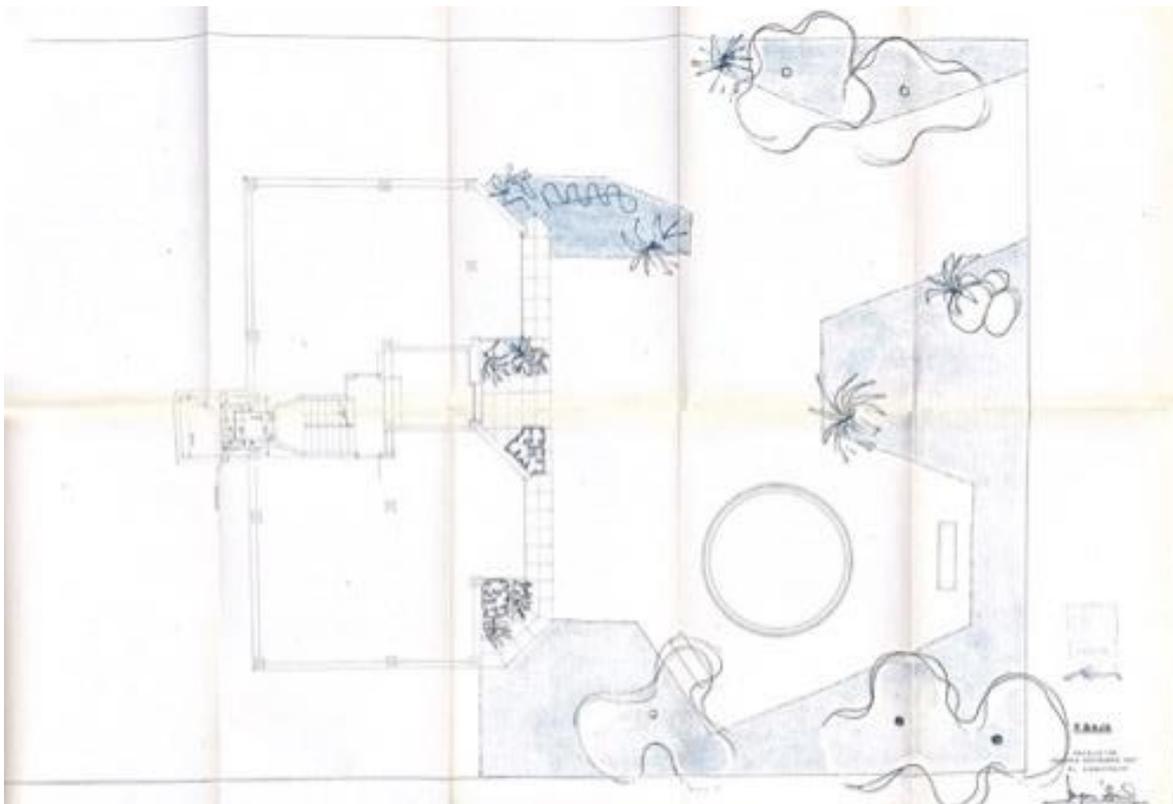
Plano de emplazamiento del edificio Torre del Montañar, Jávea 1961. (Archivo Municipal de Jávea-XA0303/4)
